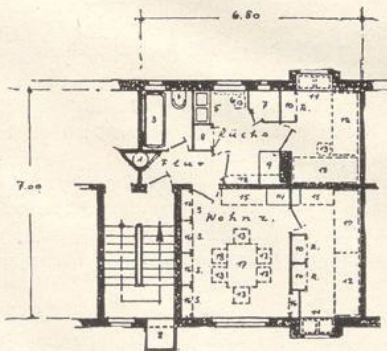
Grundriß einer Kleinwohnung. (1:200.)
